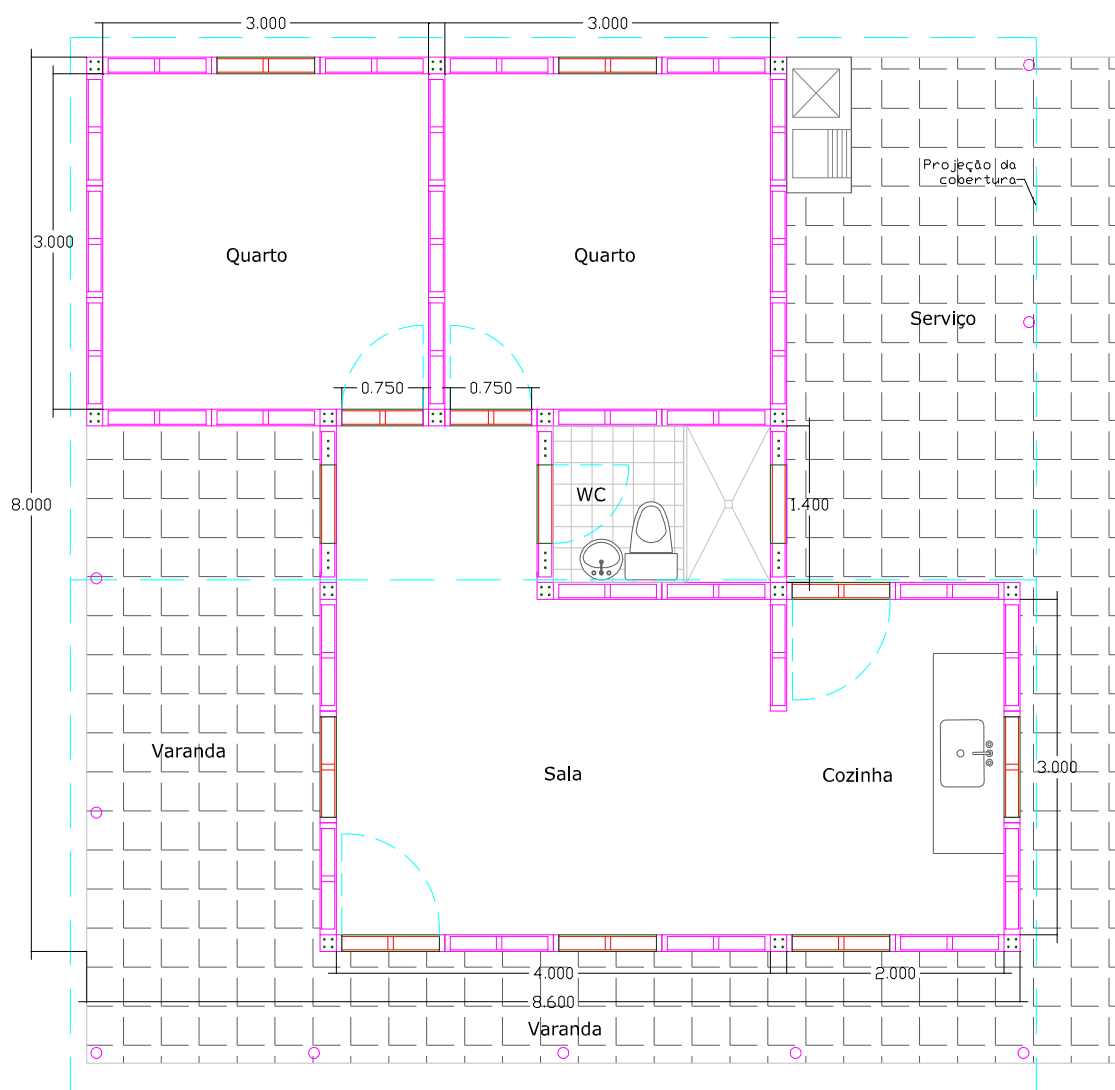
Planta baixa da residência com painéis para a segunda alternativa de sistema construtivo.
